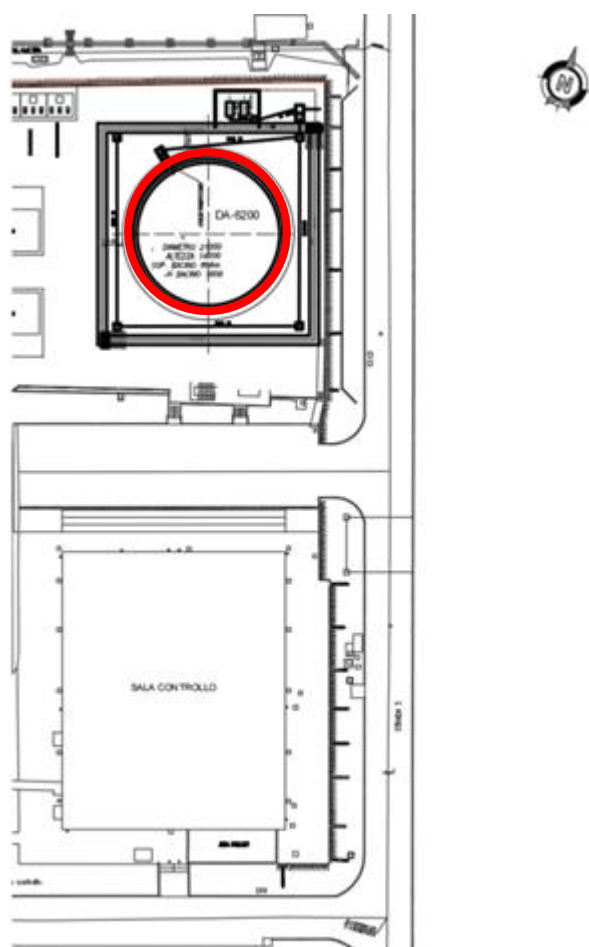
Stralcio planimetrico del serbatoio DA-6200 in zona nord Impianti Aromatici
